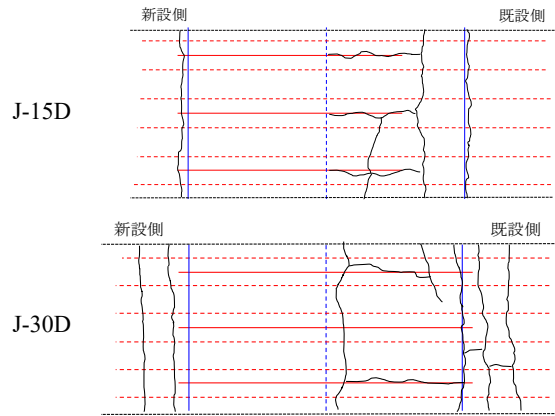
J-15D/30D梁の底面ひび割れスケッチ
